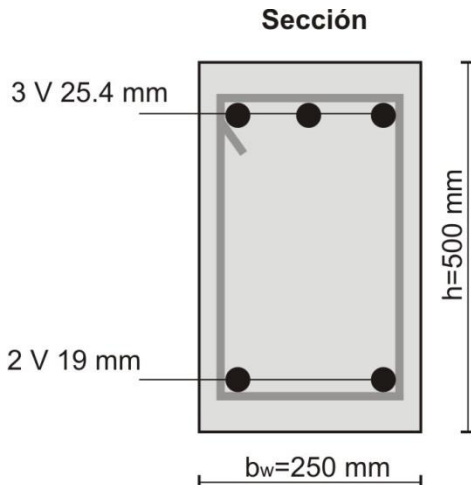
Croquis final del arreglo de varillas en la sección.
